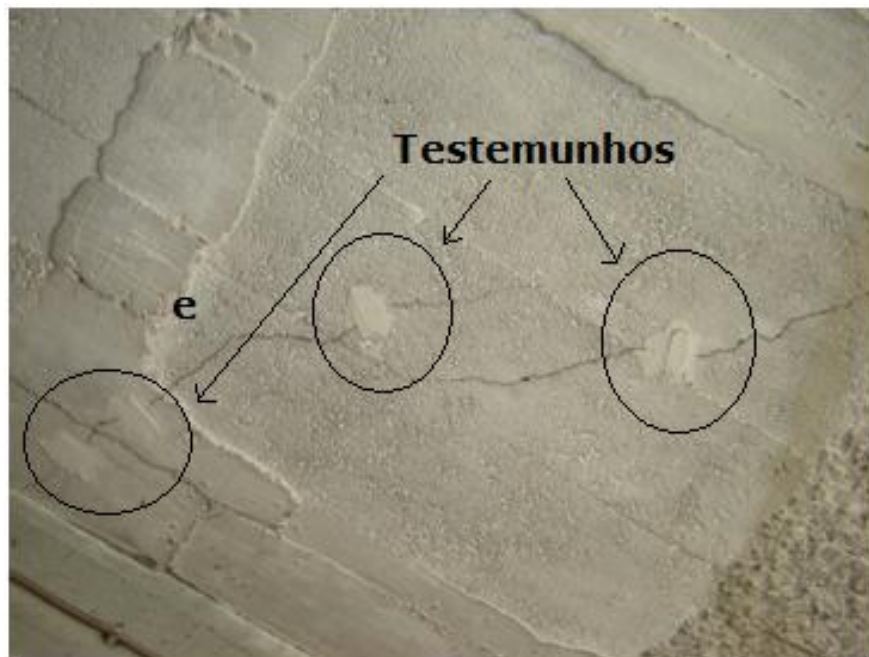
Fissura localizada com testemunhos de gesso
